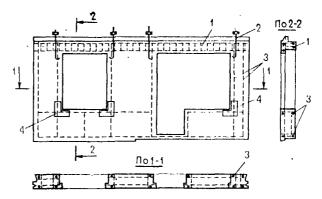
Схема армирования однослойной легкобетонной панель наружной стены
